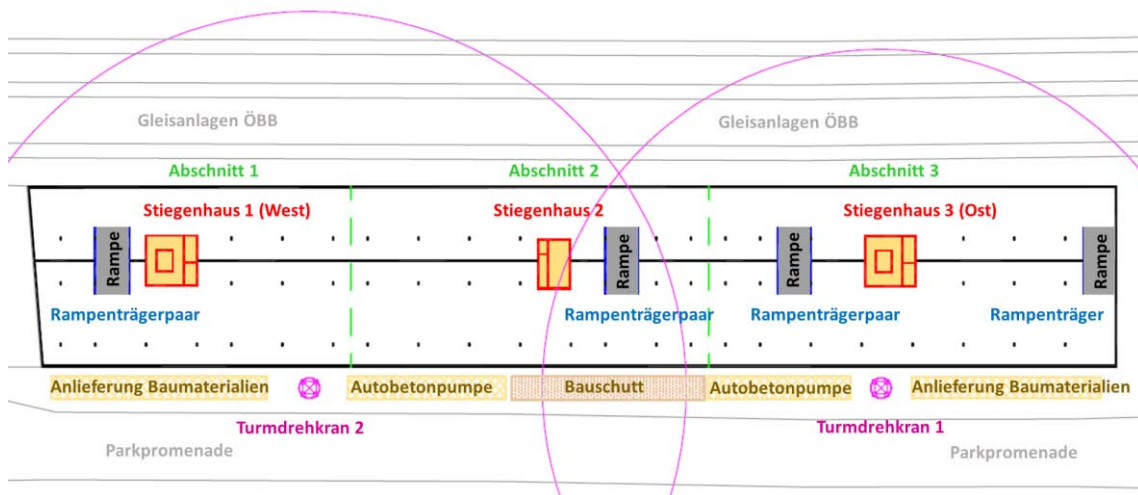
Grundriss des Parkdecks über 3. OG
